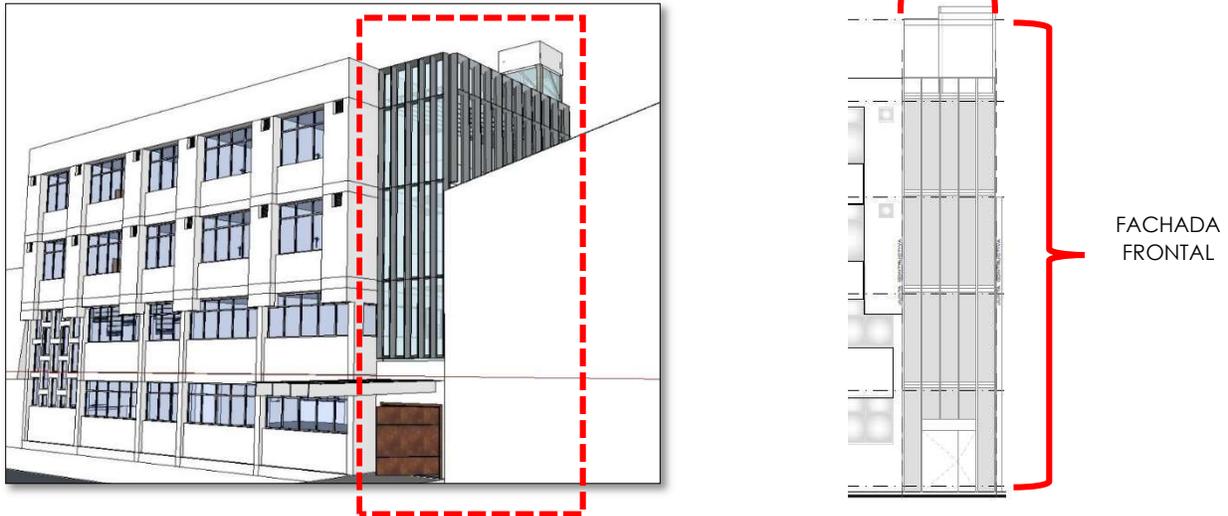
Propuesta, 3D de hall de ingreso y plano de fachada frontal.
